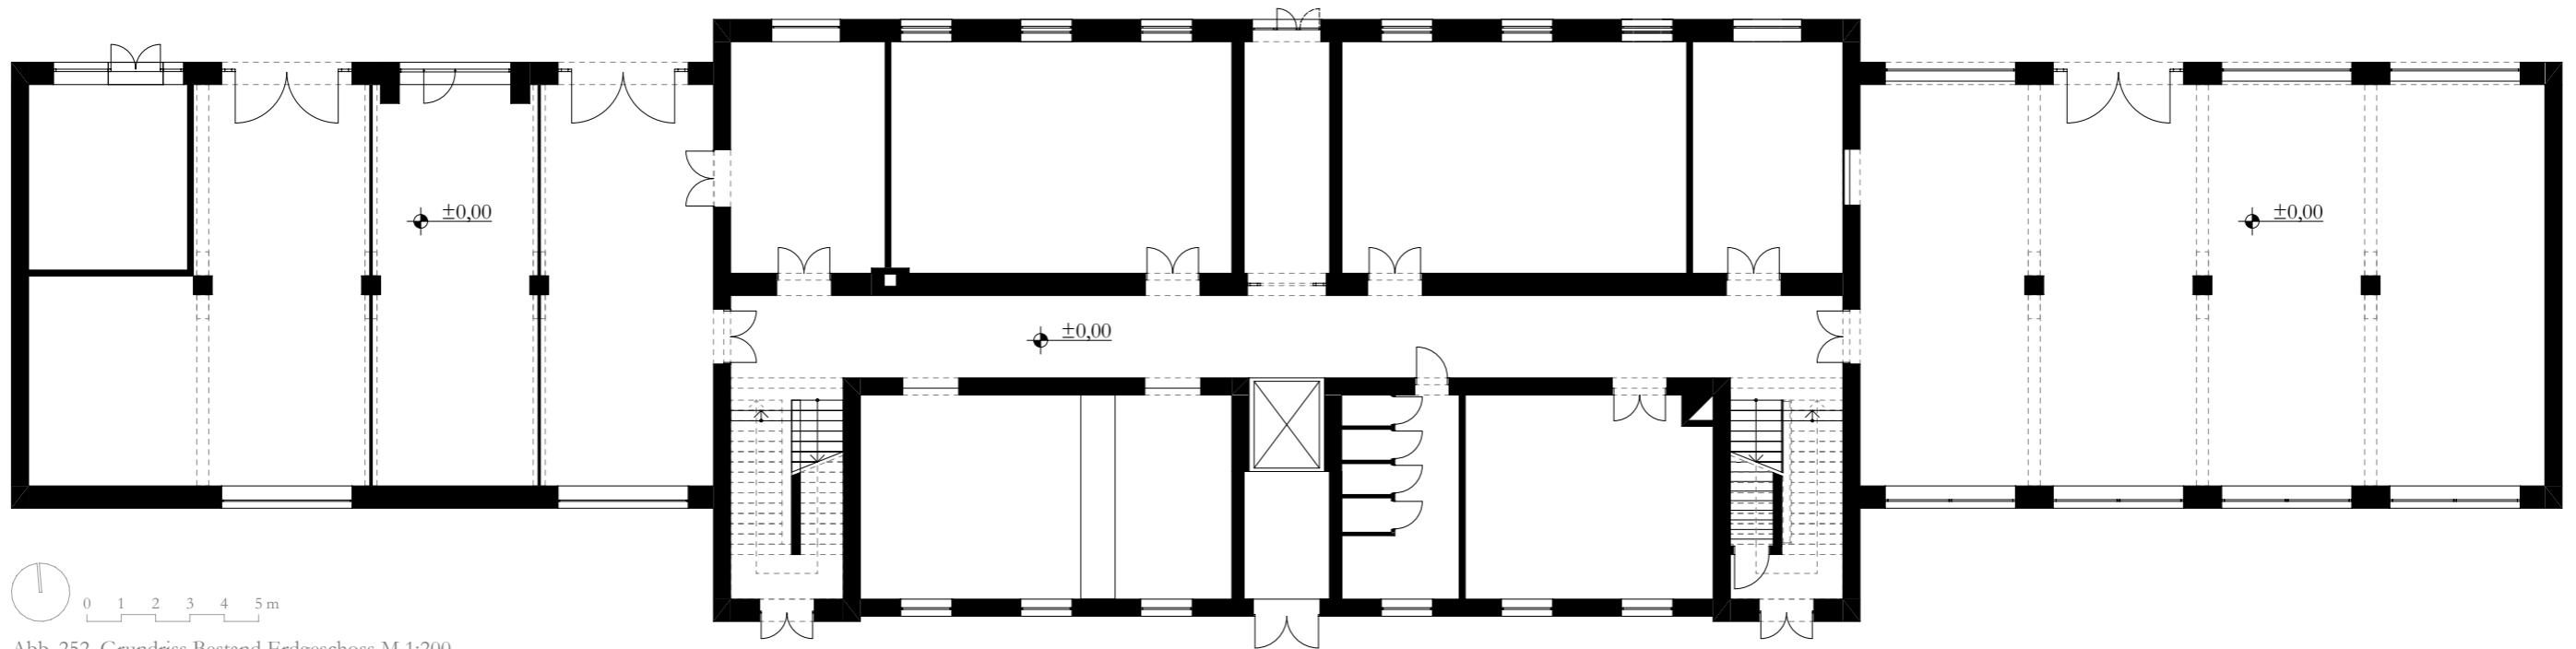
Grundriss Bestand Erdgeschoss M 1:200
